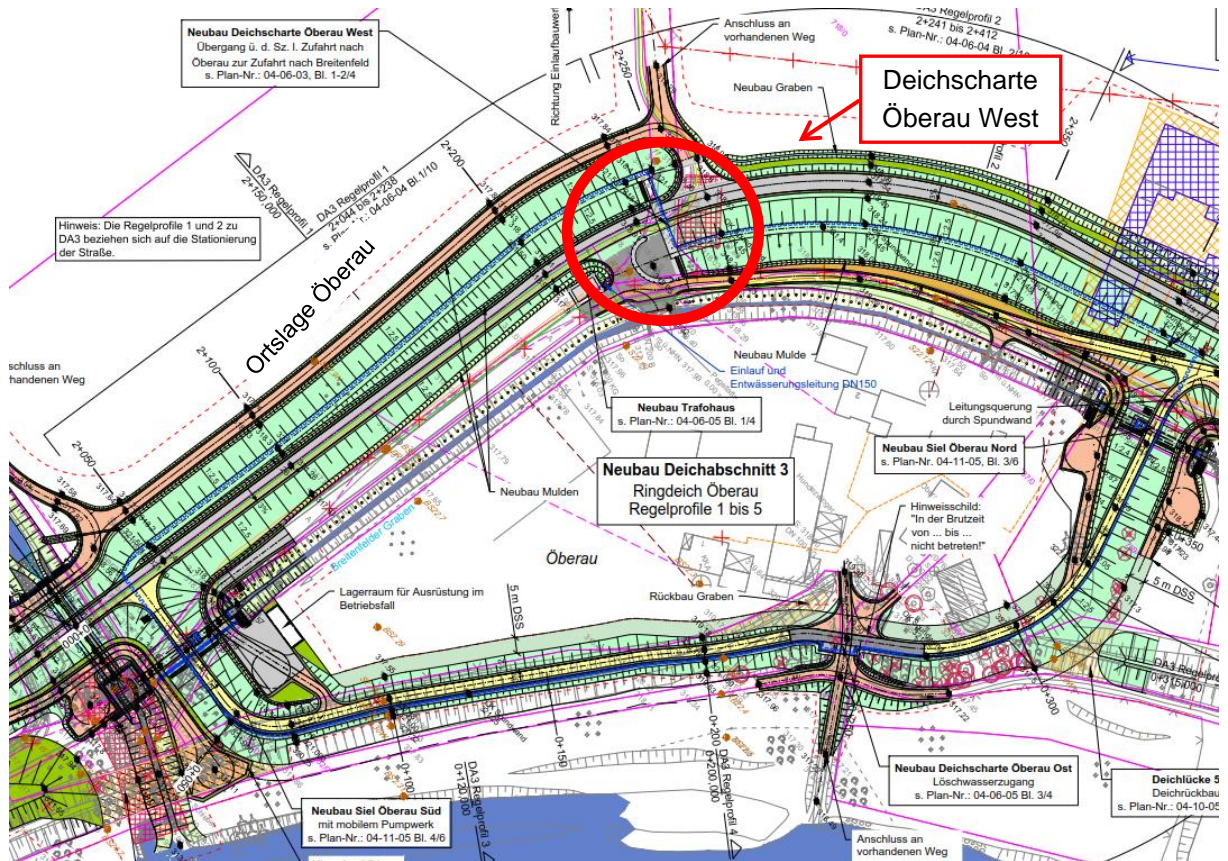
Deichscharte Öberau West, Lageplan (aus Plan 03-03-03, Blatt 2/3)
